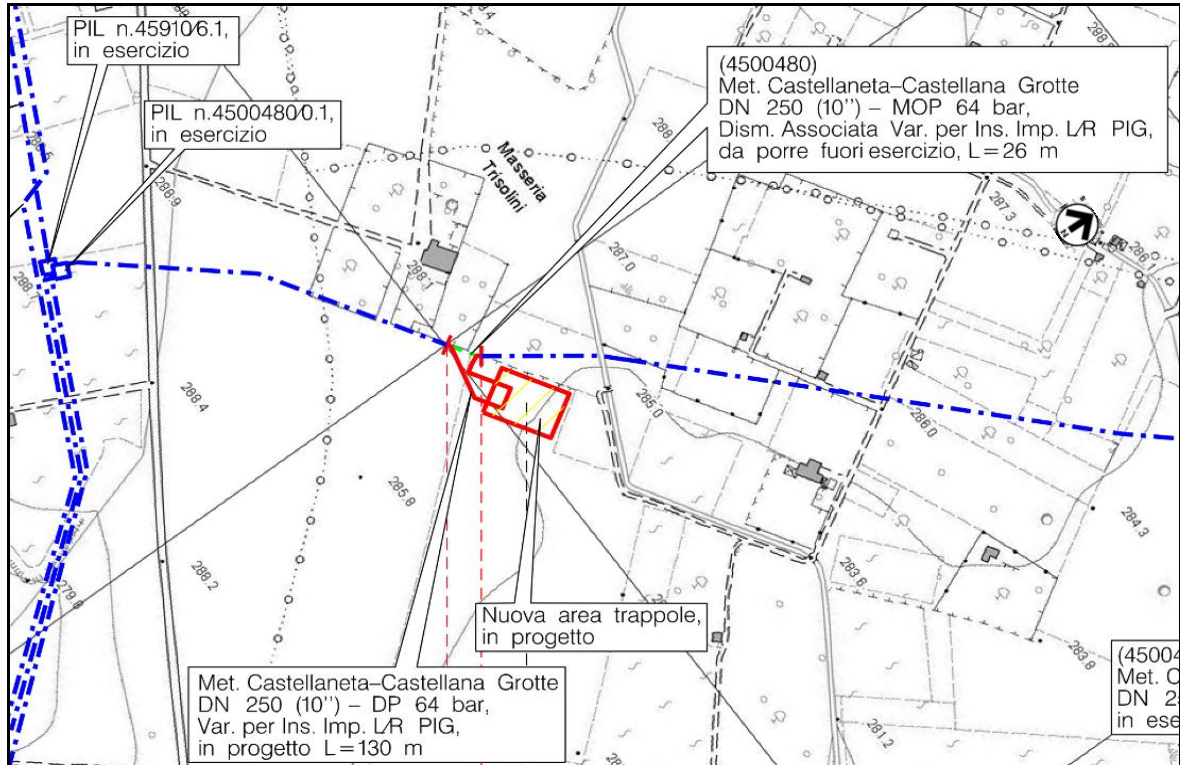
/D – Planimetria 1: 5.000 con localizzazione DI PROGETTO dell'area dell'Intervento n.1 (opere in progetto in rosso, dismissione in verde, esistente in blu)
